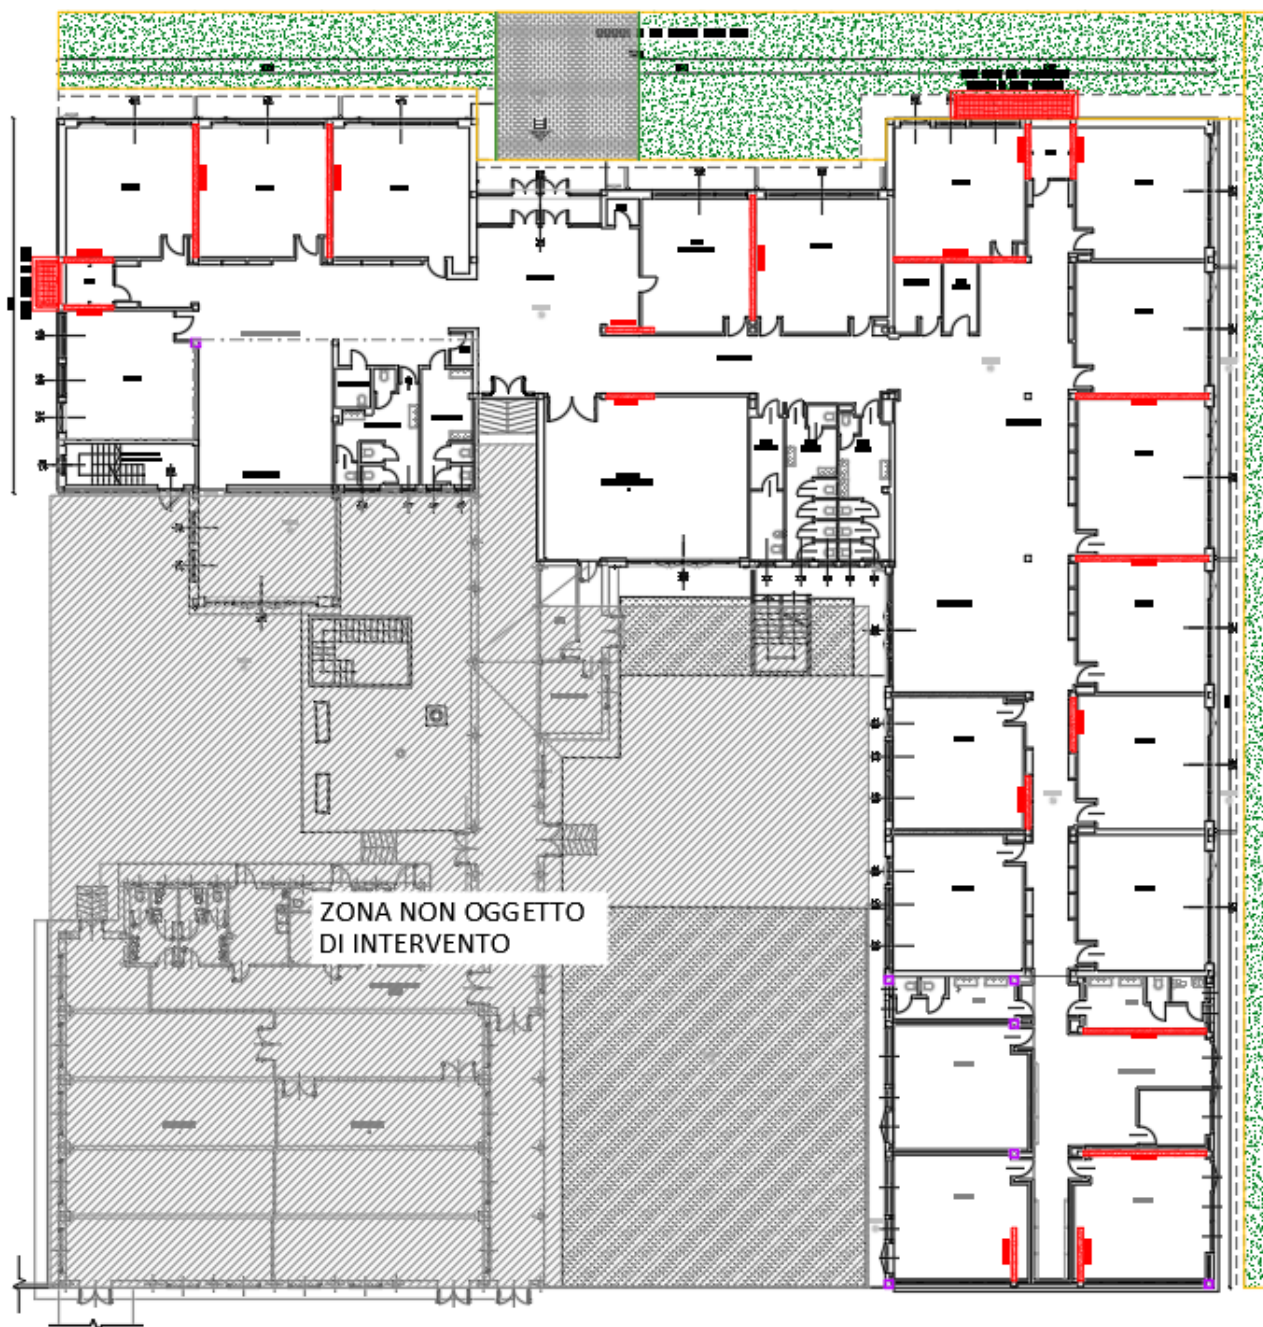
Planimetria generale con indicazione in rosso dei nuovi setti ed in magenta incamiciatura dei pilastri.
